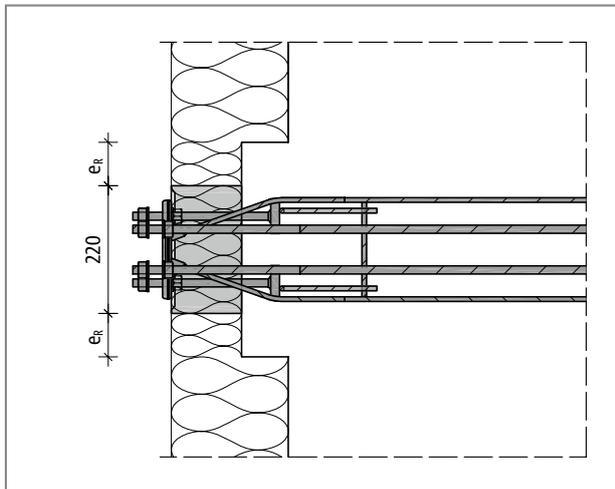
Schöck Isokorb® XT Typ SK: Randabstände
